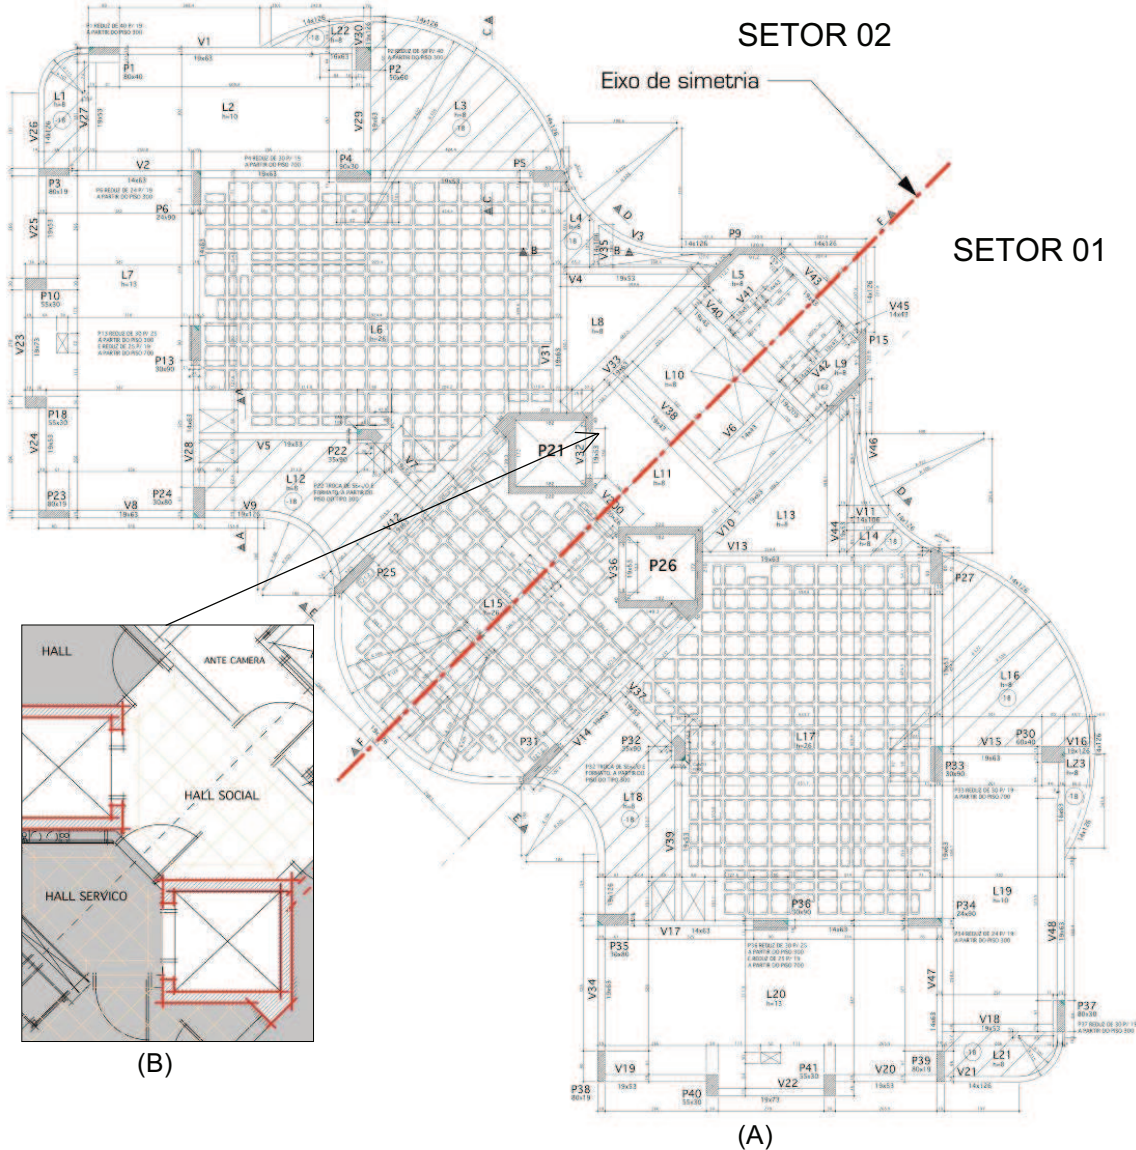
(A) Planta Baixa do Projeto Estrutural do Pavimento Tipo. (B) Detalhe — sem escala.
